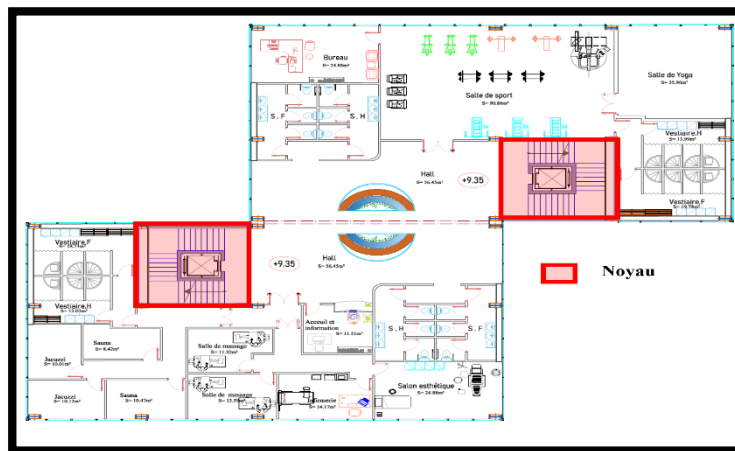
Plan 2^{ème} niveau / noyaux centraux.
